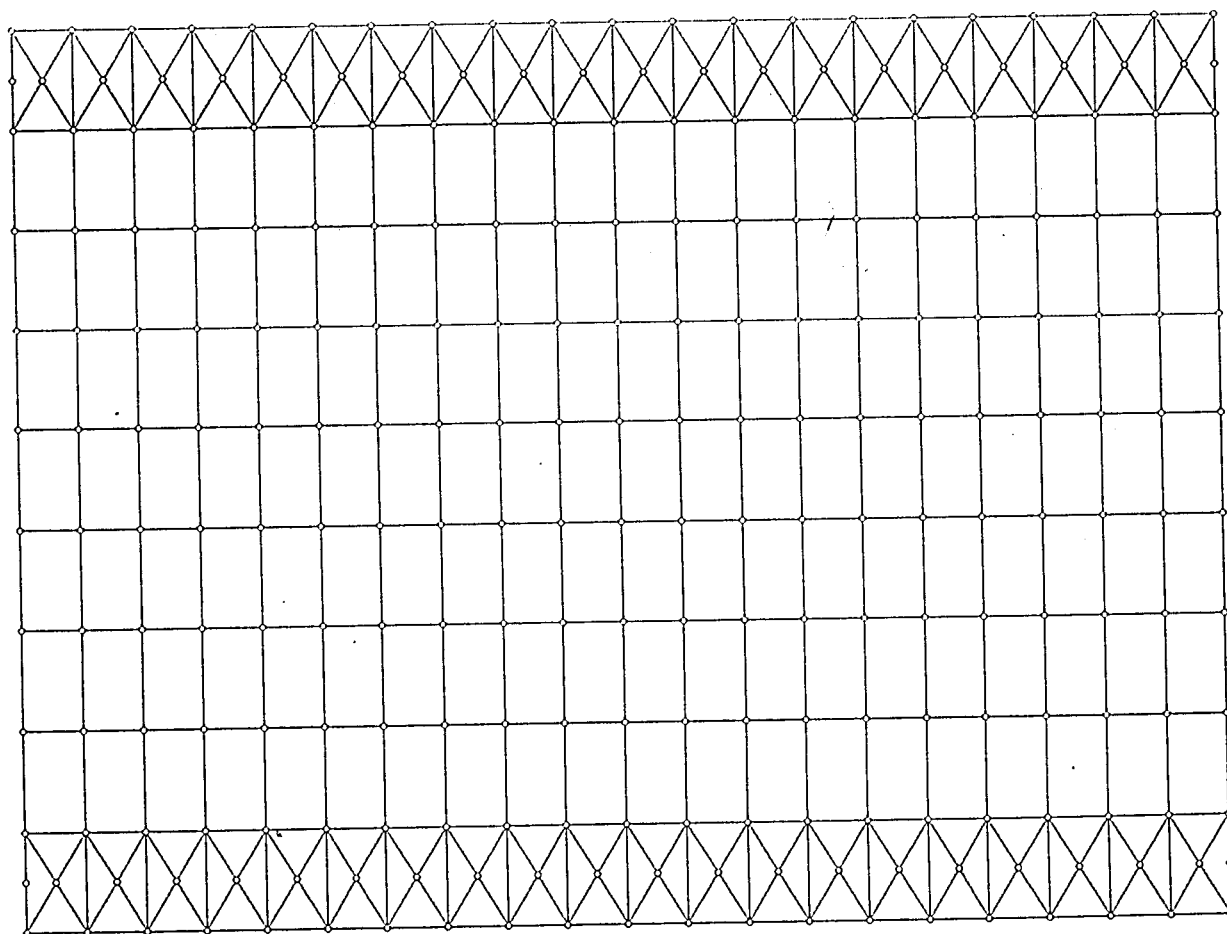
Nave industrial. Modelação estrutural: planta.
